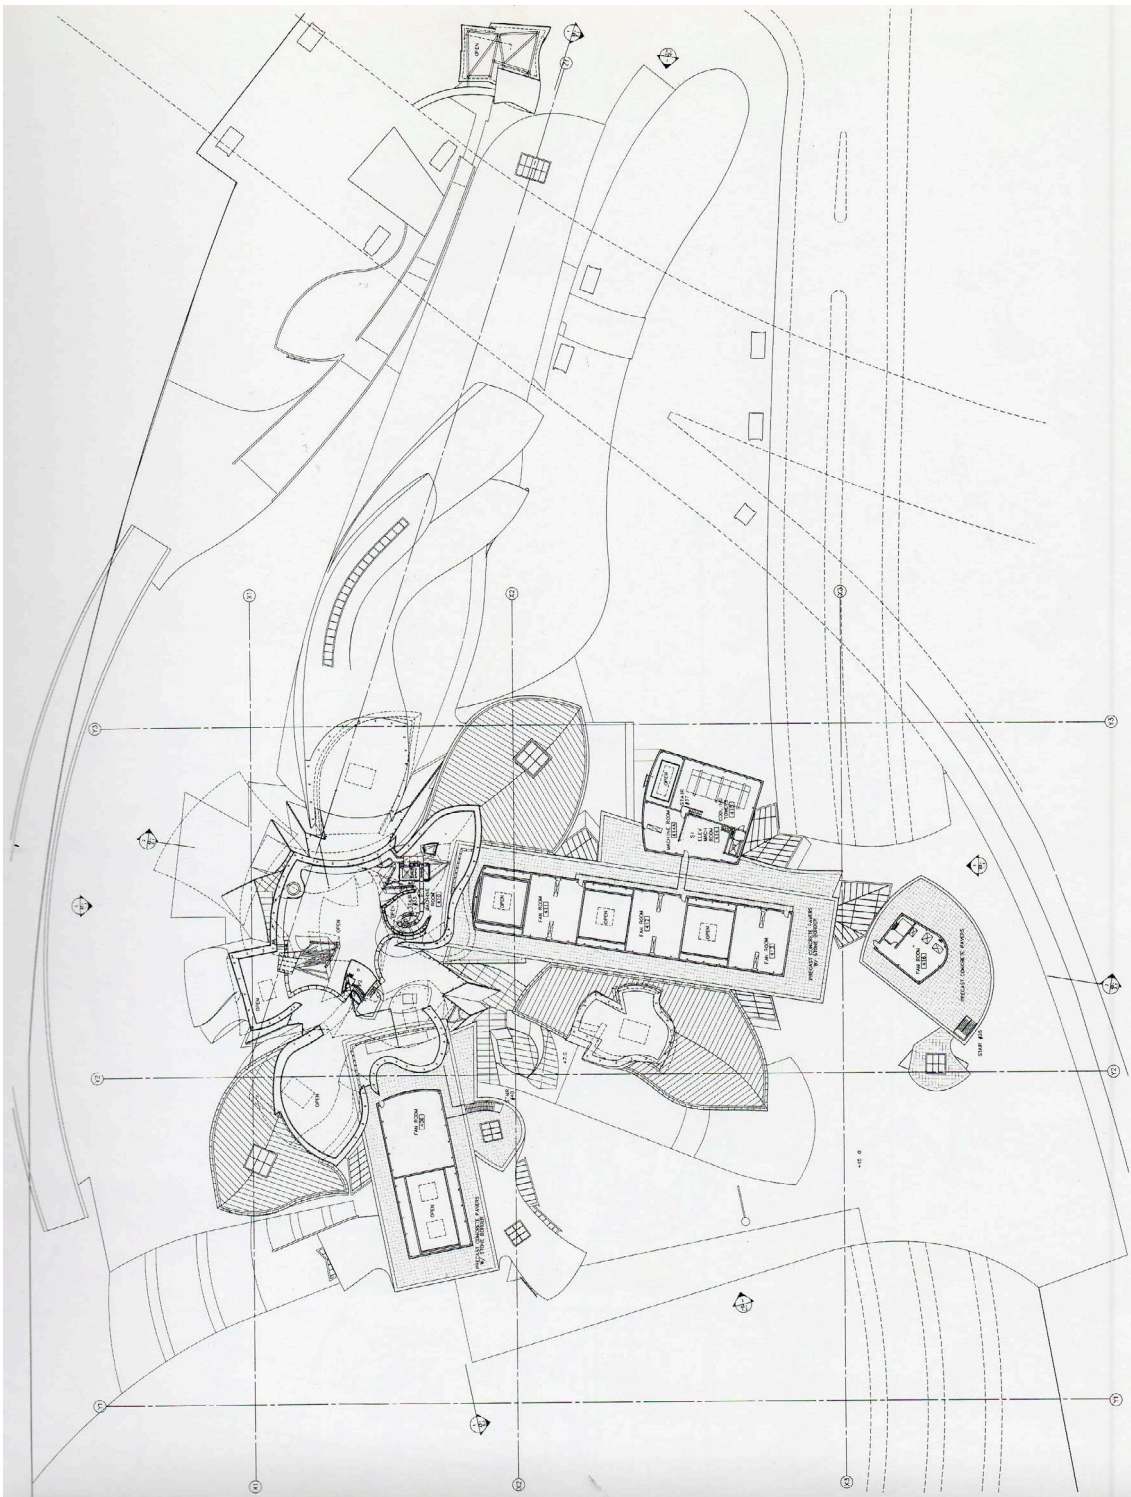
Frank Gehry, Ausführplan Guggenheim Museum, Grundriss 4. Geschöß, Technik und Dachdraufsicht
